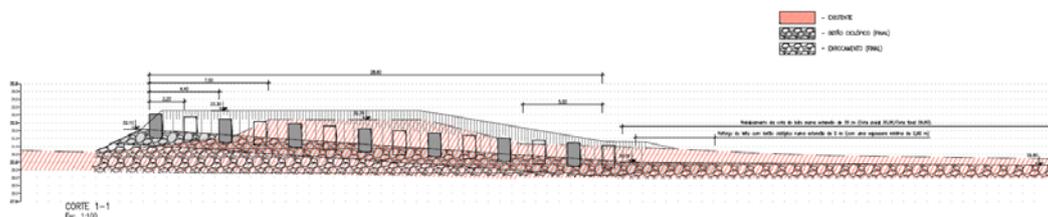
Corte longitudinal da rampa para peixes do açude de Penacova,
